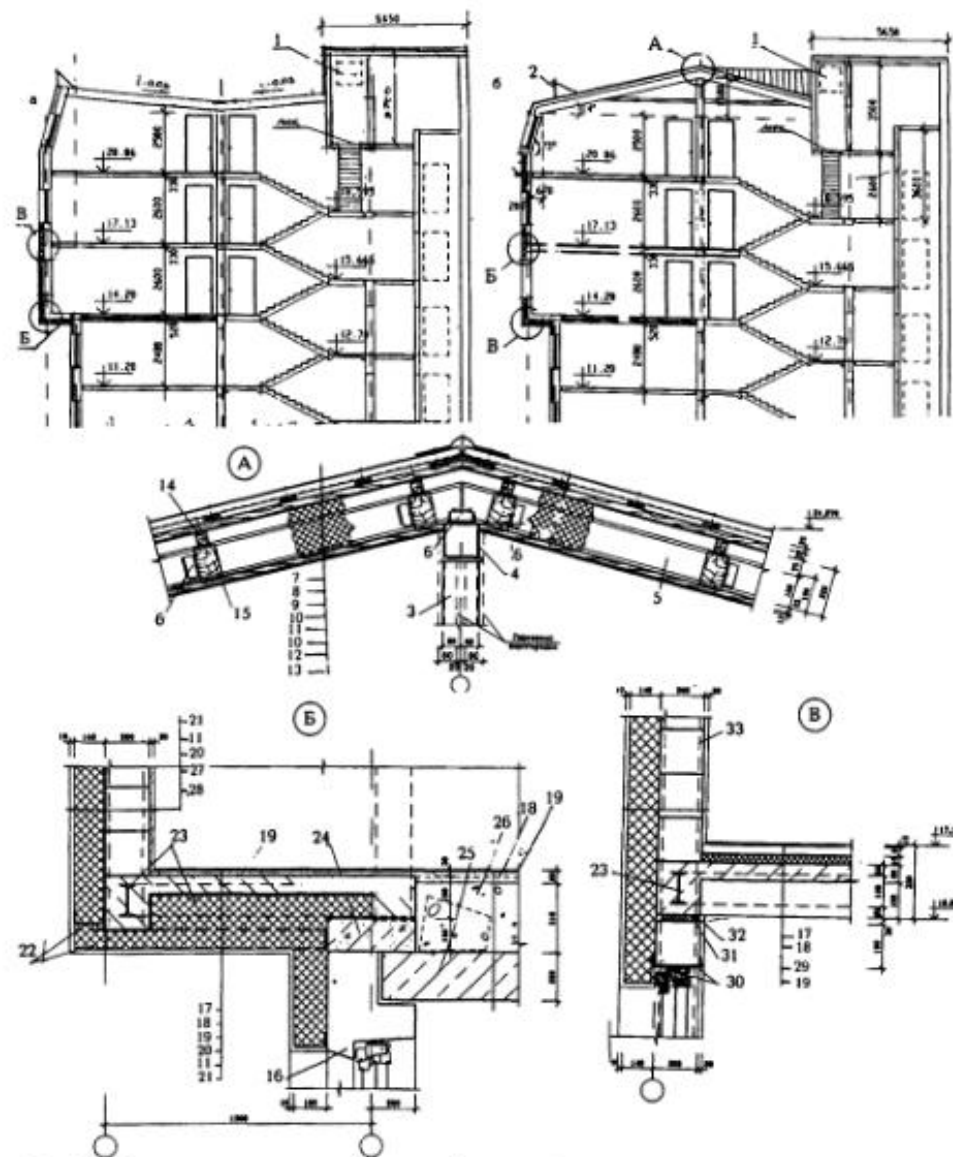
Трехэтажные мансардные надстройки с металлическим каркасом для пятиэтажных домов "первого поколения": а – поперечный разрез надстройки при внутреннем водостоке; б – то же, при наружном; 1 – выход на крышу; 2 – ограждение крыши; 3 – стальная стойка из трубы квадратного сечения 160x160x5; 4 – балка того же сечения; 5 – сварная стропильная конструкция из I № 16; 6 – опорный уголок 50x5,  $l = 100$ ; 7 – металлочерепица; 8 – обрешетка; 9 – контробрешетка; 10 – защитная пленка; 11 – утеплитель  $\lambda = 0,04$  Вт/м<sup>2</sup>С; 12 – обрешетка; 13 – гипсокартон; 14 – прогон для крепления обрешетки под гипсокартонную облицовку мансарды; 16 – наружная стена надстраиваемого здания; 17 – линолеум; 18 – цементно-песчаная стяжка; 19 – монолитная железобетонная плита; 20 – пароизоляция; 21 – штукатурка; 22 – гнутый тонкостенный металлический профиль; 23 – стальная балка; 24 – монолитная железобетонная обвязка; 25 – существующий настил перекрытия; 26 – насыпной керамзит; 27 – стеновые блоки из автоклавного ячеистого бетона; 28 – штукатурка; 29 – сплошной звукоизоляционный слой; 30 – стальной уголок; 31 – упругая прокладка; 32 – герметик; 33 – стальная стойка.
